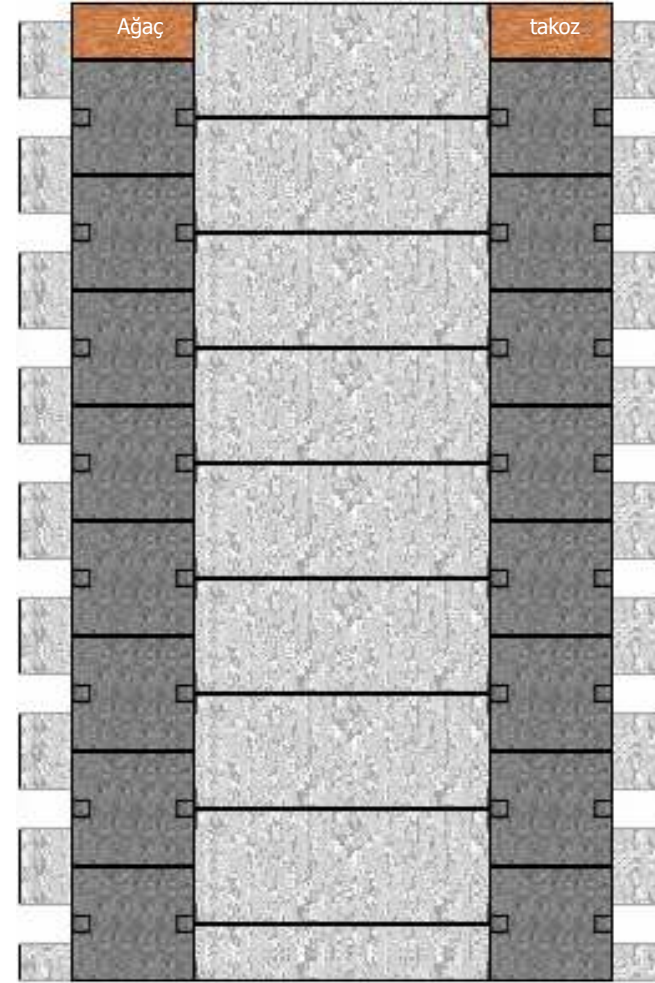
a. Boyunduruklara paralel olarak yerleştirilecek beton blok elemanları
